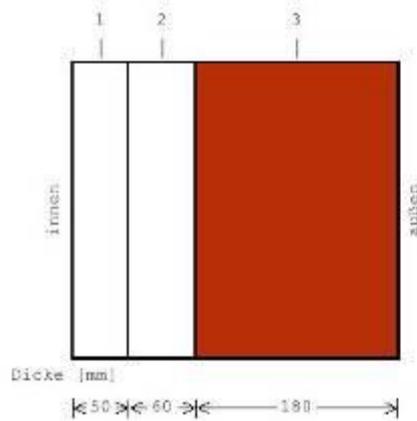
Aufbau oberste Geschossdecke RH\_B
